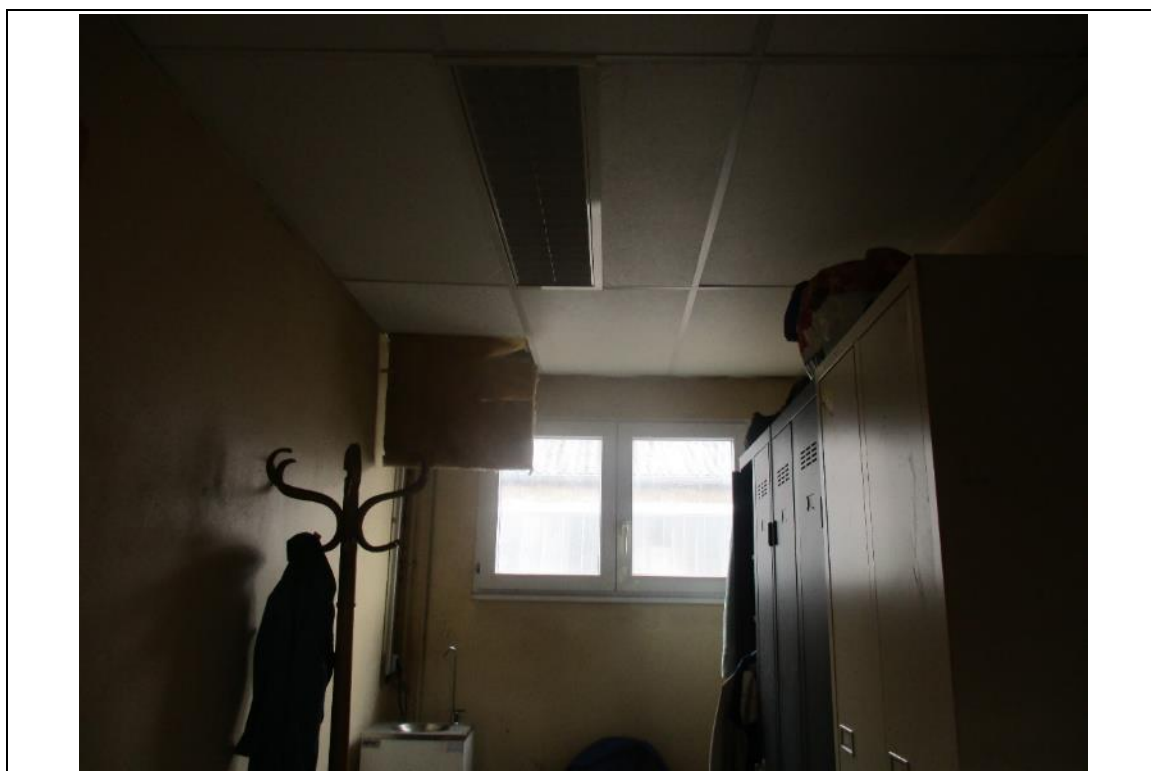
Eclats de revêtement - Local 012, chaufferie 162G
